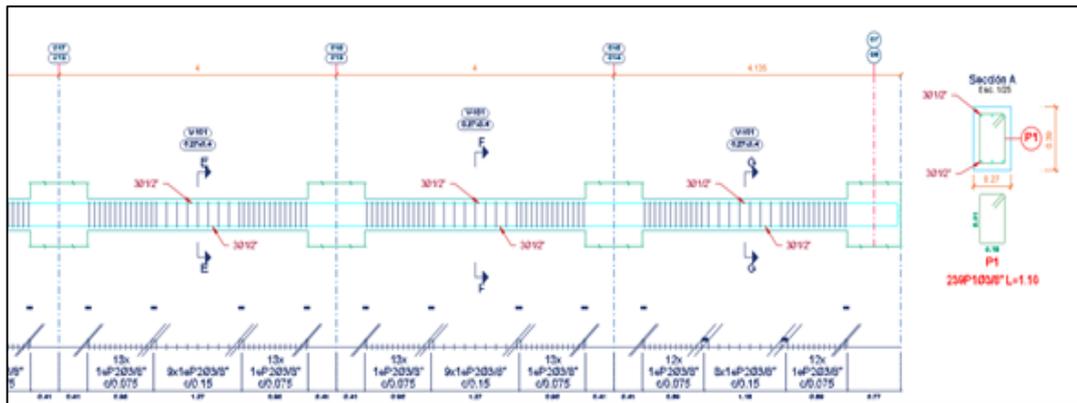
VIGA EN LA DIRECCION X-X EJES A-A Y C-C- MODULO I
